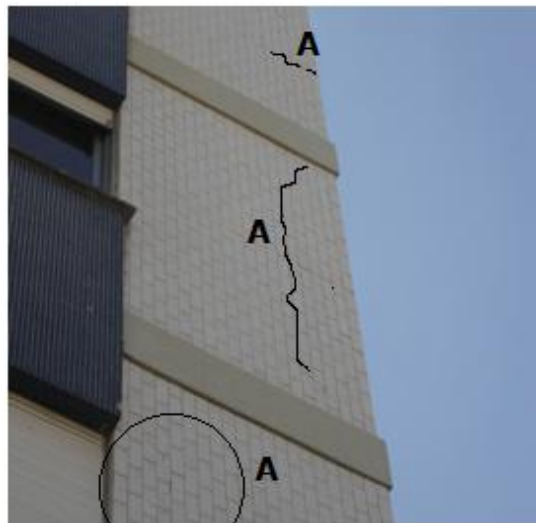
Fissuras/Fendas na parede “A”
